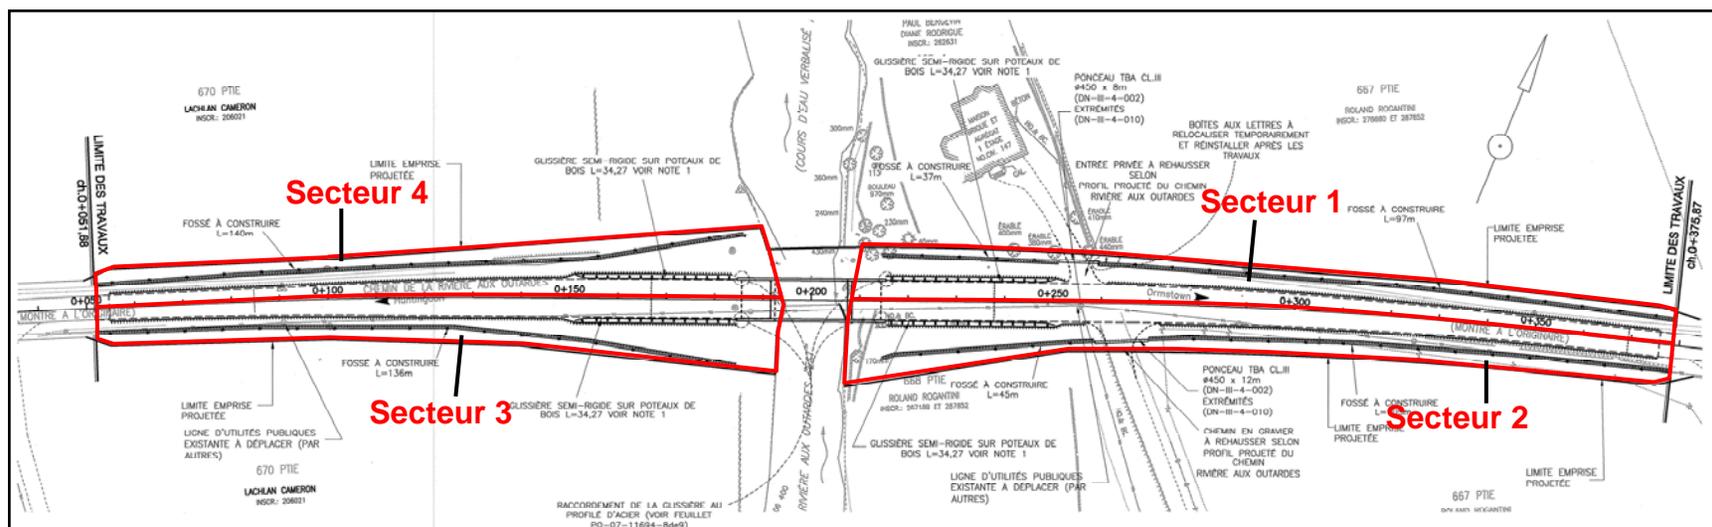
Localisation des secteurs inventoriés, projet n° 154-99-1041 (source : Ministère des Transports, plan d'ensemble [extrait], Plan et profil – Chemin de la rivière aux Outardes, plan CH-8707-154-99-1041 (4/7), 30 avril 2010)
